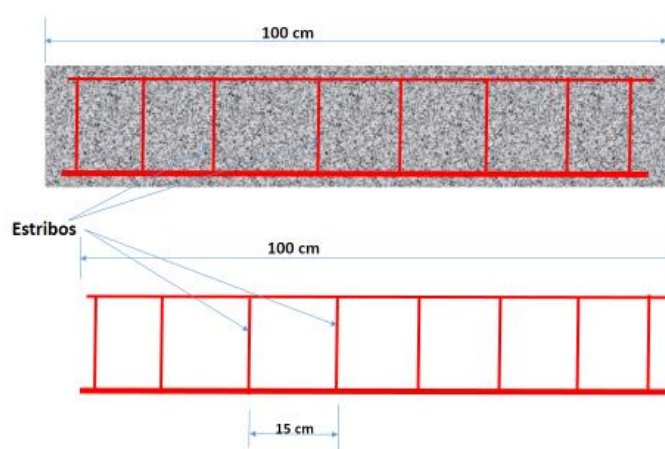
detalhe da viga reforçada em aço(corte longitudinal)
